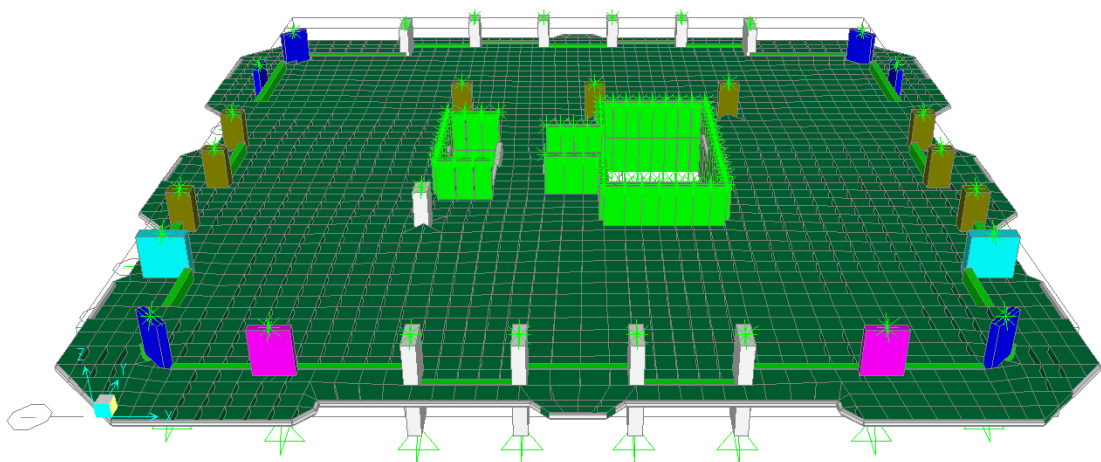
Modelo tridimensional de uma laje do piso elevado.
